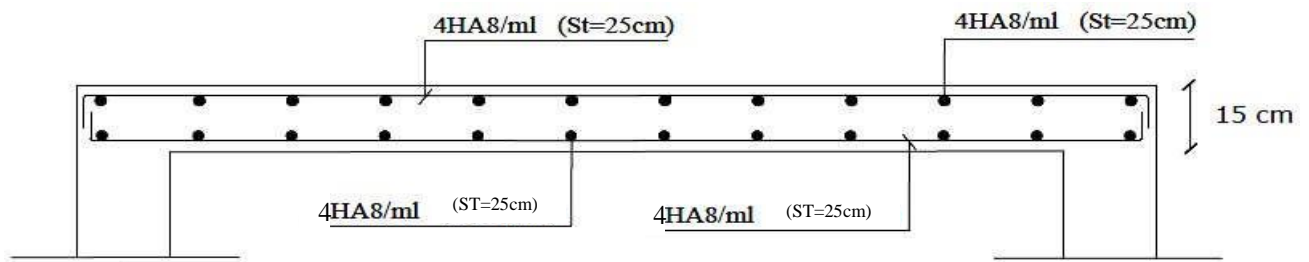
Schéma du ferrailage de la dalle pleine de la salle machine (sens x-x et y-y).
